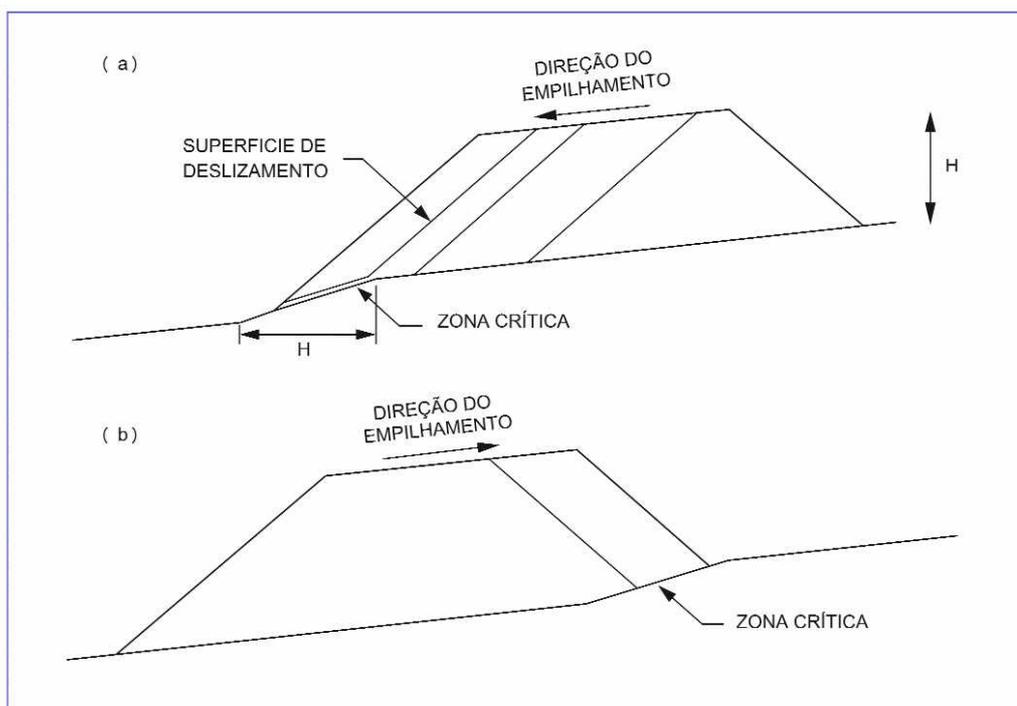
influência da técnica de construção na estabilidade da pilha: a) empilhamento para jusante; b) empilhamento para montante (Smith e Giroud, 2000).
